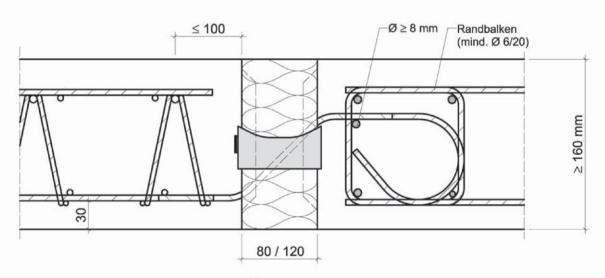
Beispiel Schöck Isokorb<sup>®</sup> Typ Q mit Aufhängebewehrung nach Abschn. 3.1.5 und Ausführung als Randbalken.
